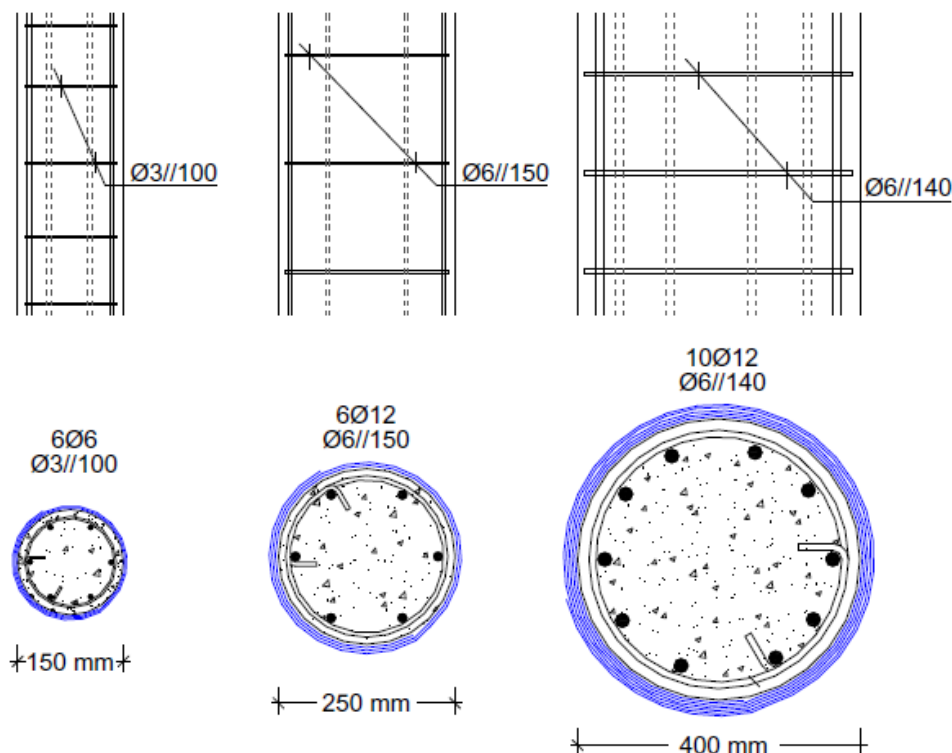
Pormenorização das armaduras das 3 colunas [19]
